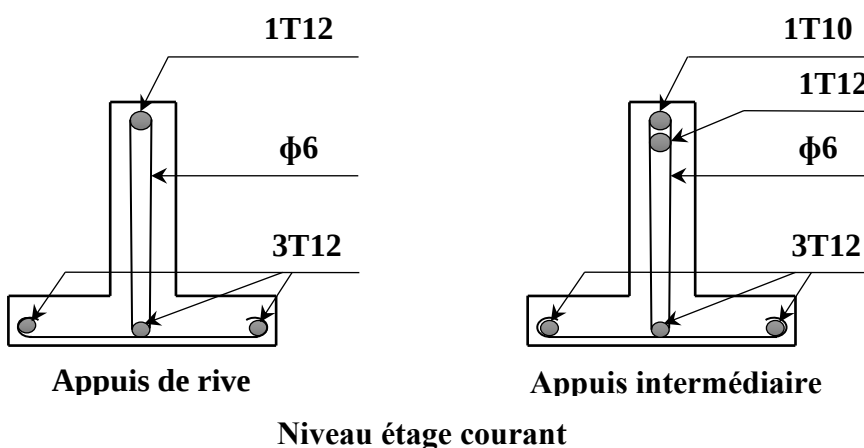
Dessin de ferrailage des poutrelles des étages courants .
